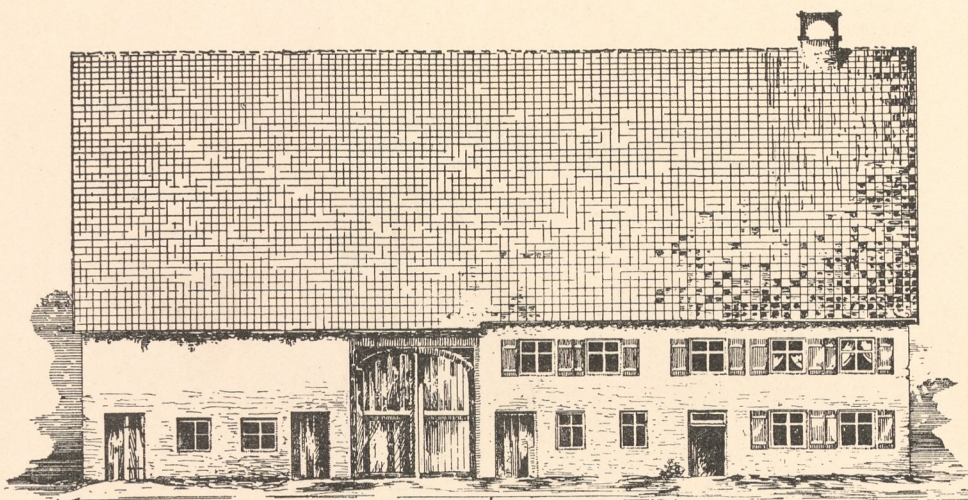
Bauernhaus Nr. 127 in Babenhausen. (1527.) Hofansicht.
